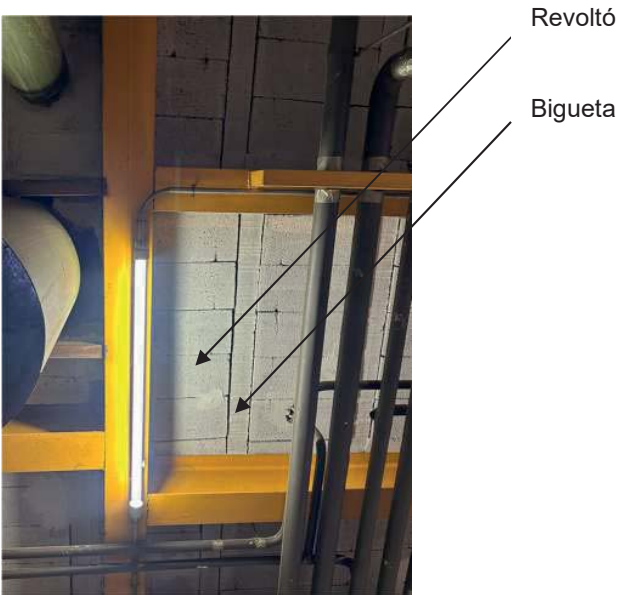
Fotografia de la cara inferior del sostre de planta baixa
